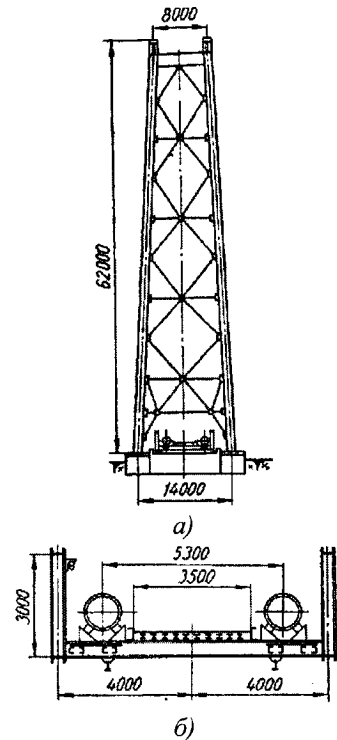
Елементи переходу через р. Амудар'ю: а – пілон; б – поперечний переріз
